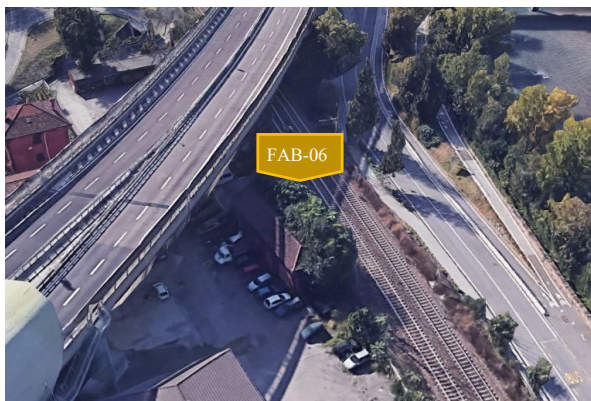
Foto 3D Google Earth - Demolizioni zona centro manutenzione ANAS
